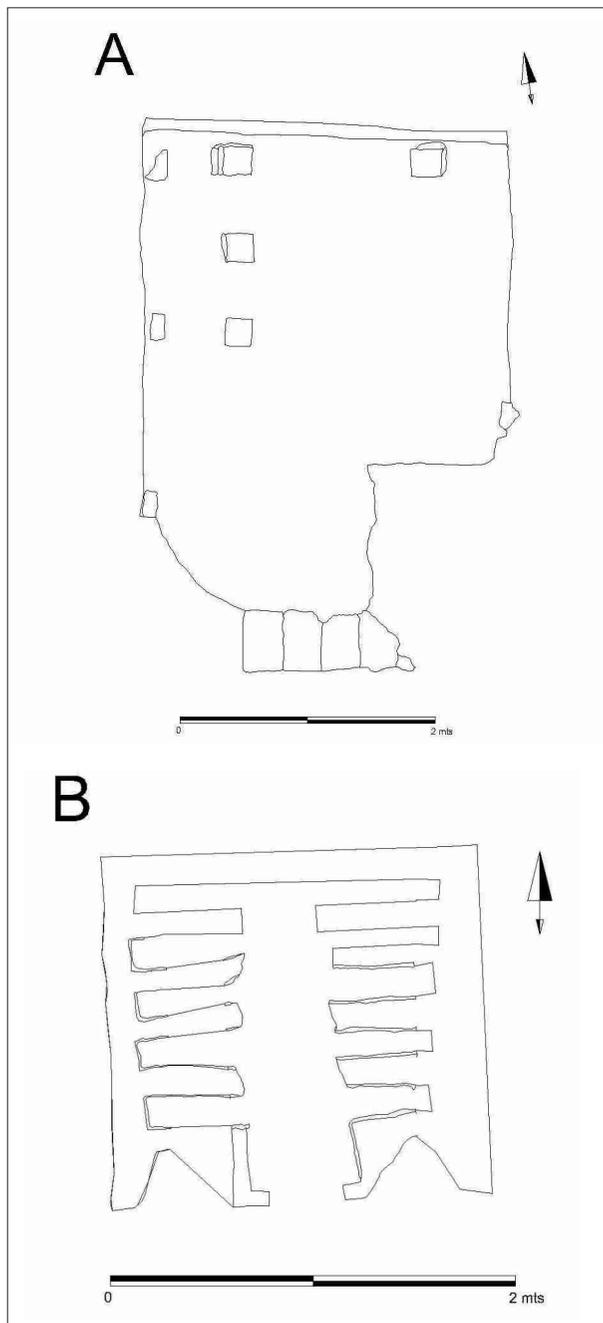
A: Horno W. B: Reconstrucción la planta del horno E.
